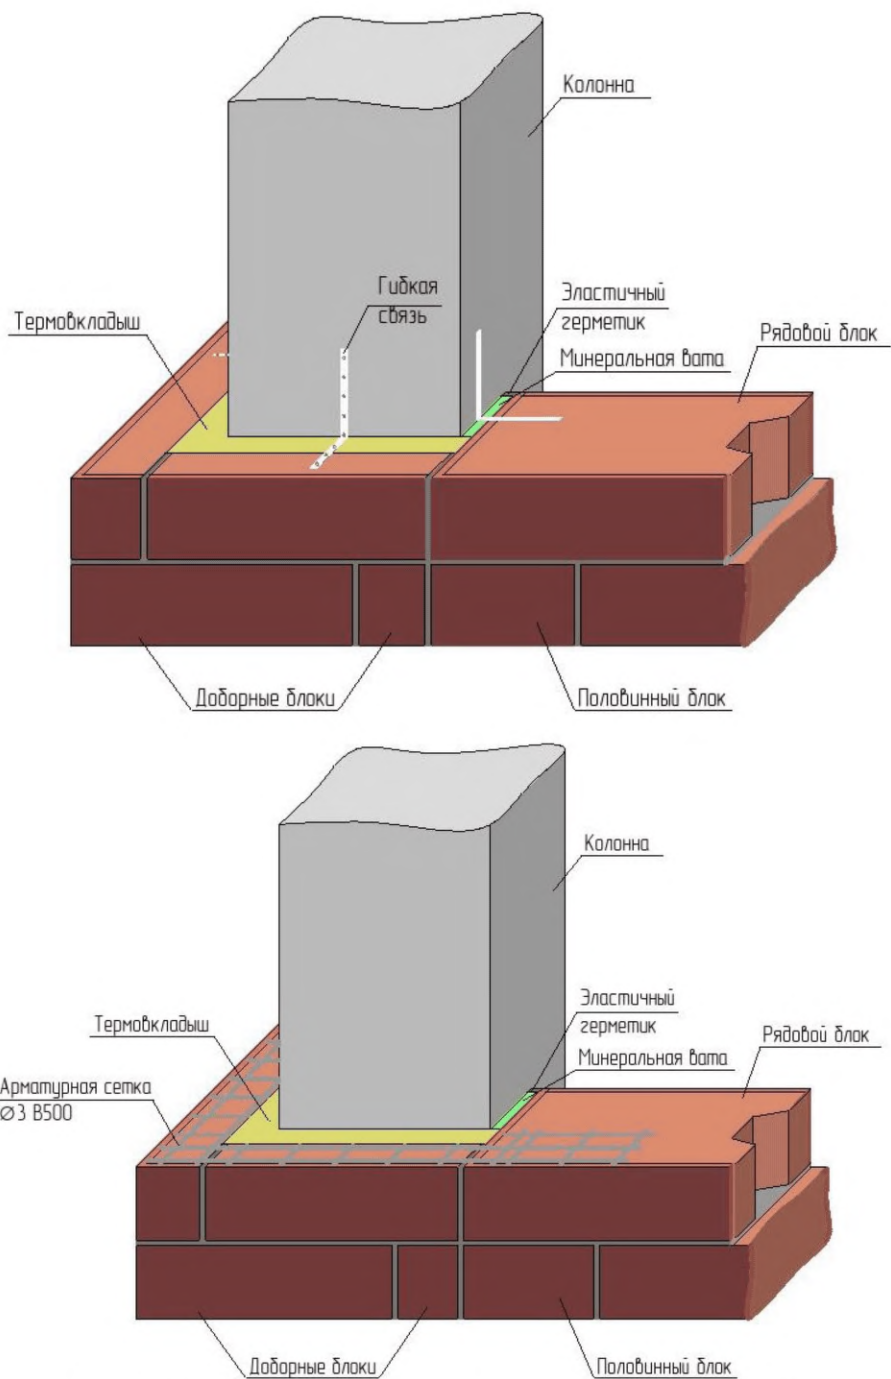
Пример сопряжения стены с железобетонной колонной.
